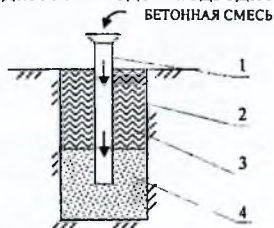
Схема бетонирования подземных сооружений методом «стена в грунте»:
